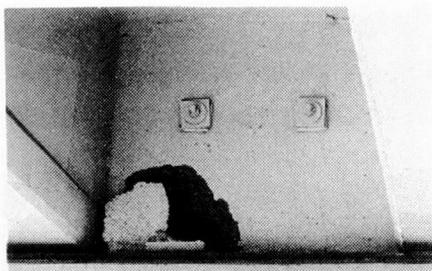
アンカーキャップ部のコンクリートの剥離剥落
